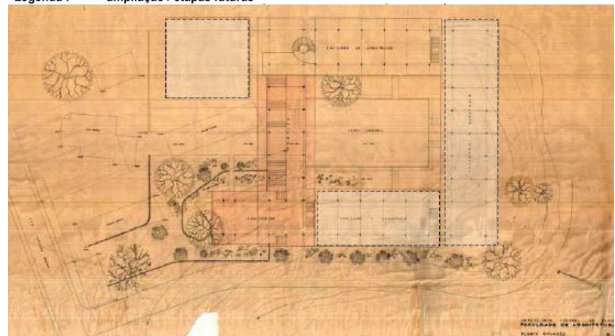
| Planta Baixa Geral (modulação da estrutura & etapas)
